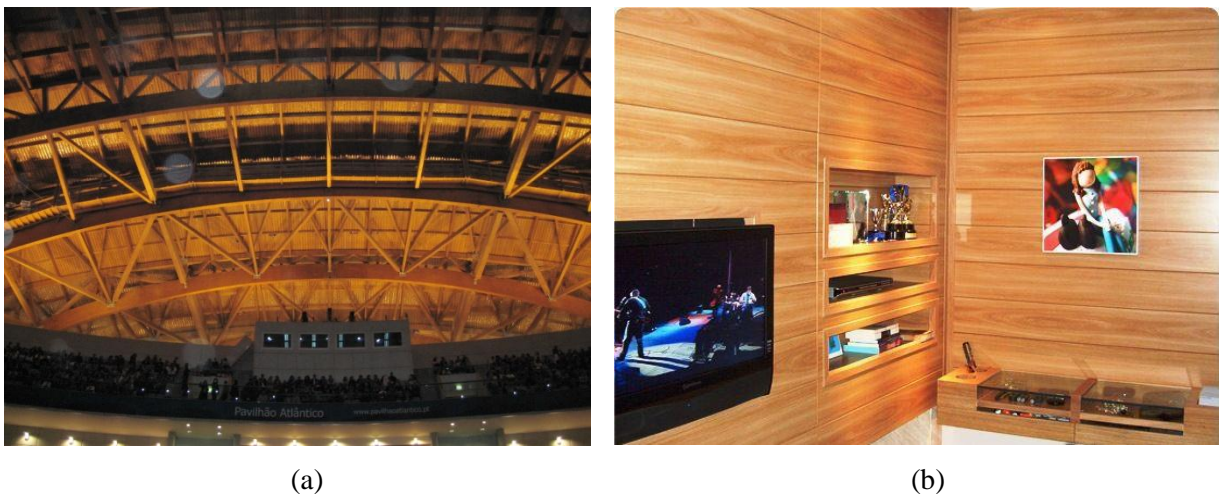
(a) Aplicação estrutural: Cobertura do Pavilhão Atlântico, Lisboa; e (b) Aplicação não estrutural: revestimento interior de habitação
